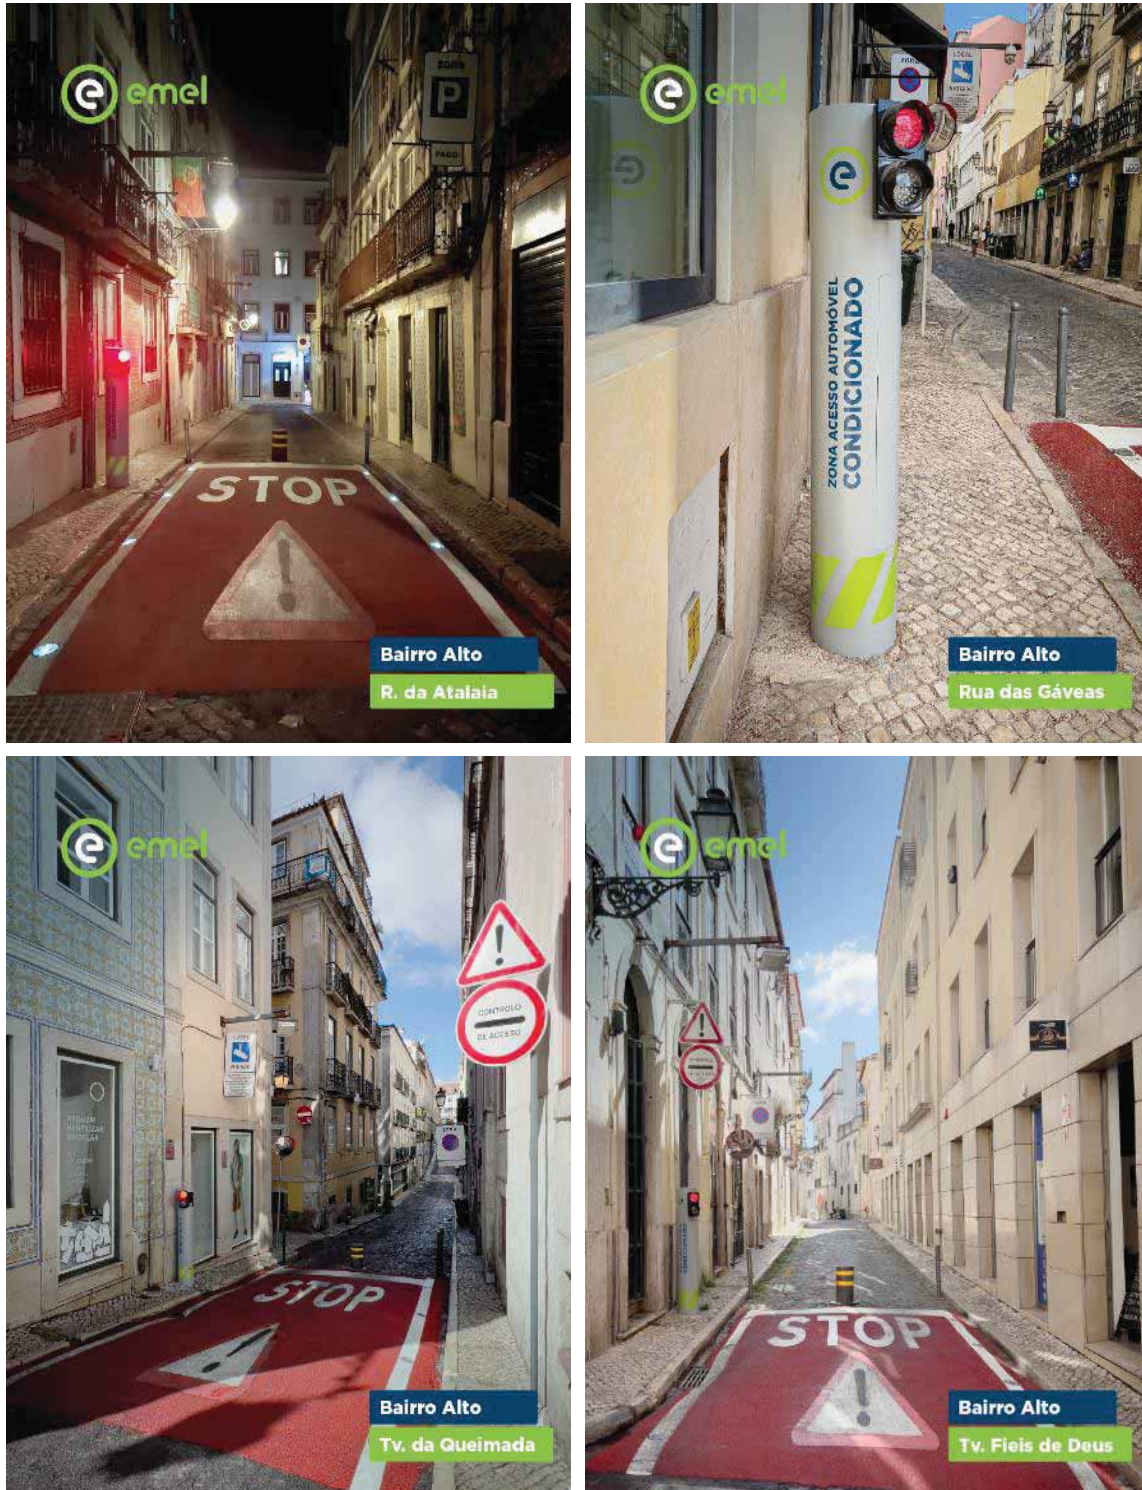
Repavimentação, repintura e renovação de Sinalização ZAAC Bairro Alto
